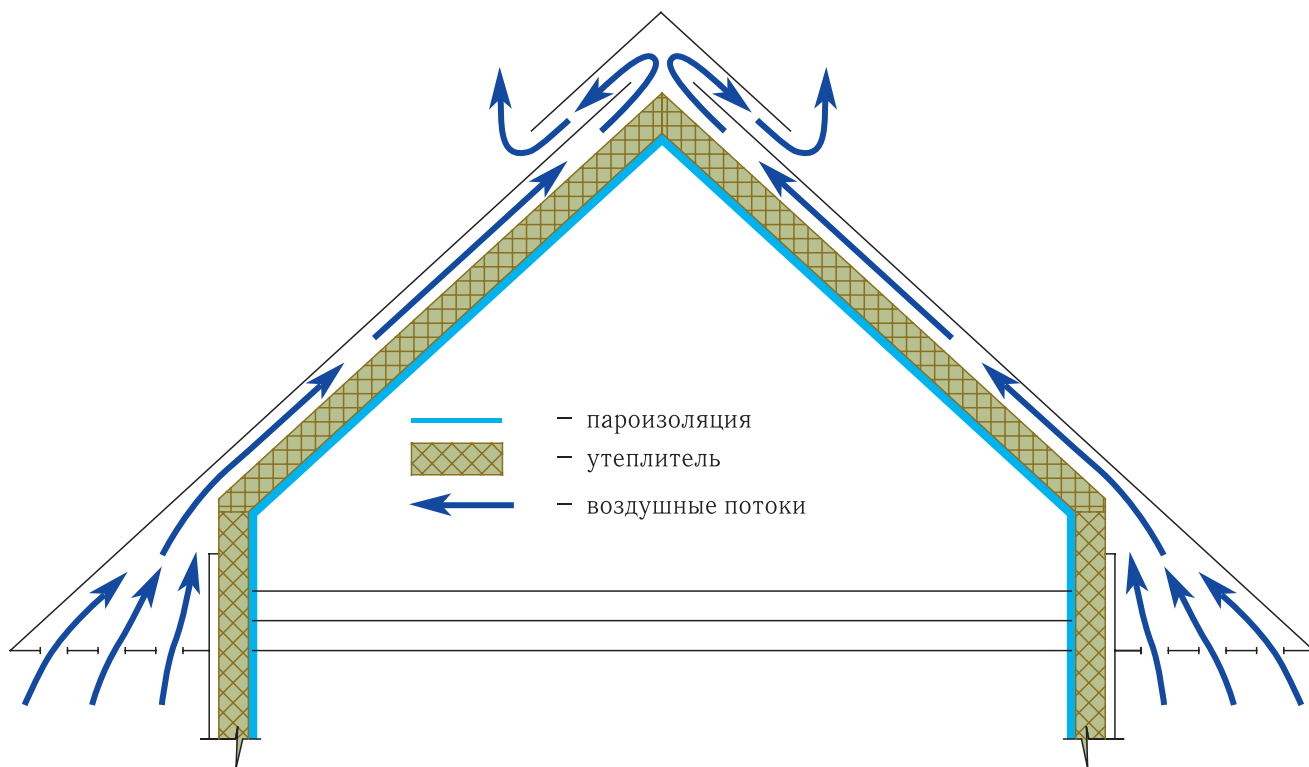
Схема утепления, пароизоляции и вентиляции мансарды
